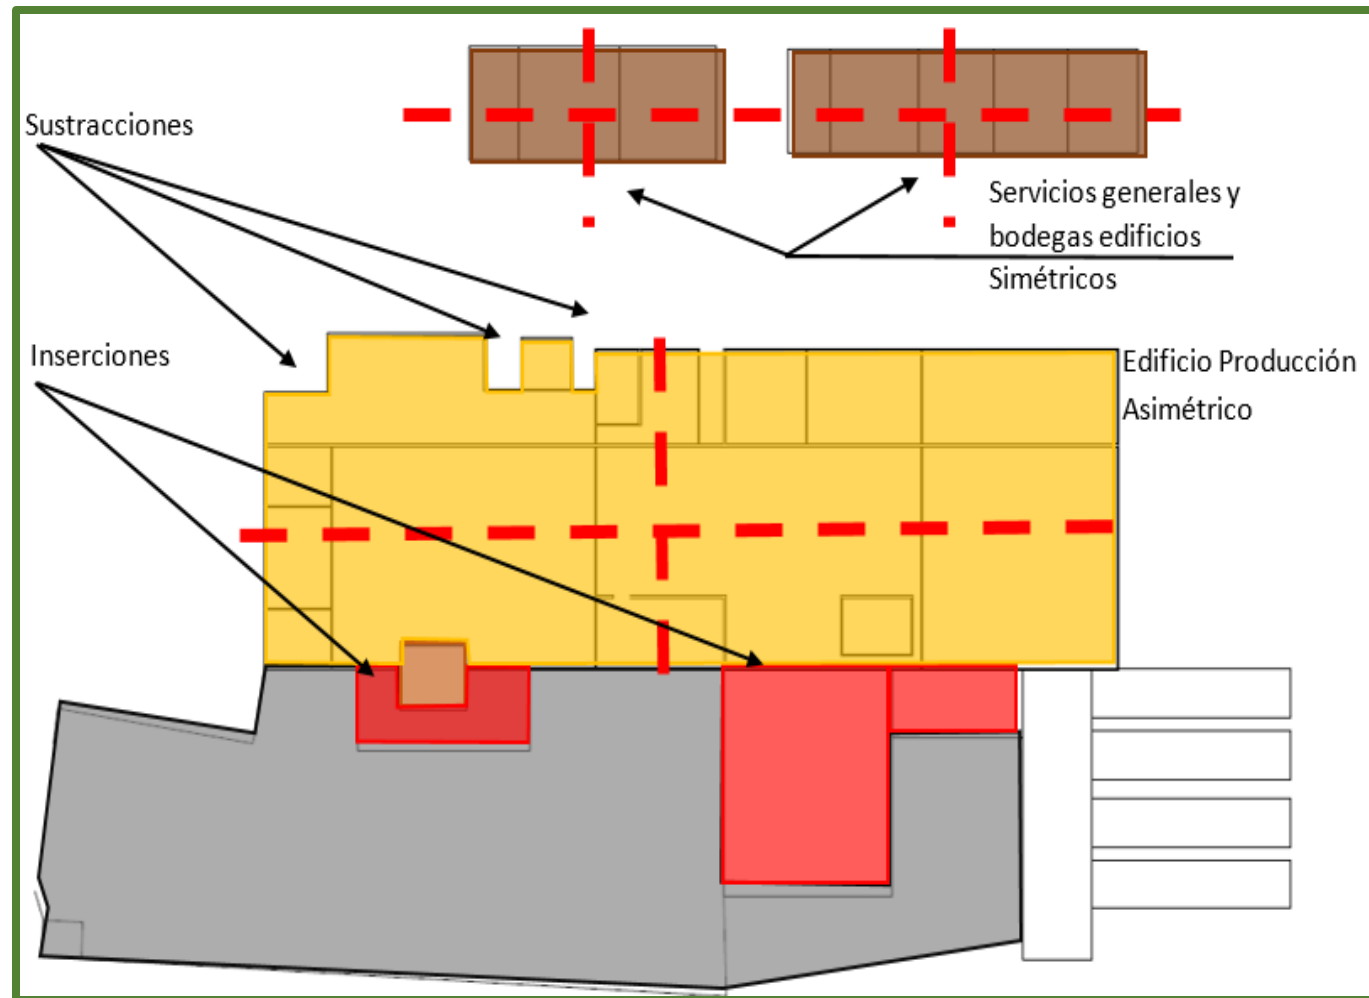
Análisis Formal Plano elaborado en base a la primera visita de campo.
